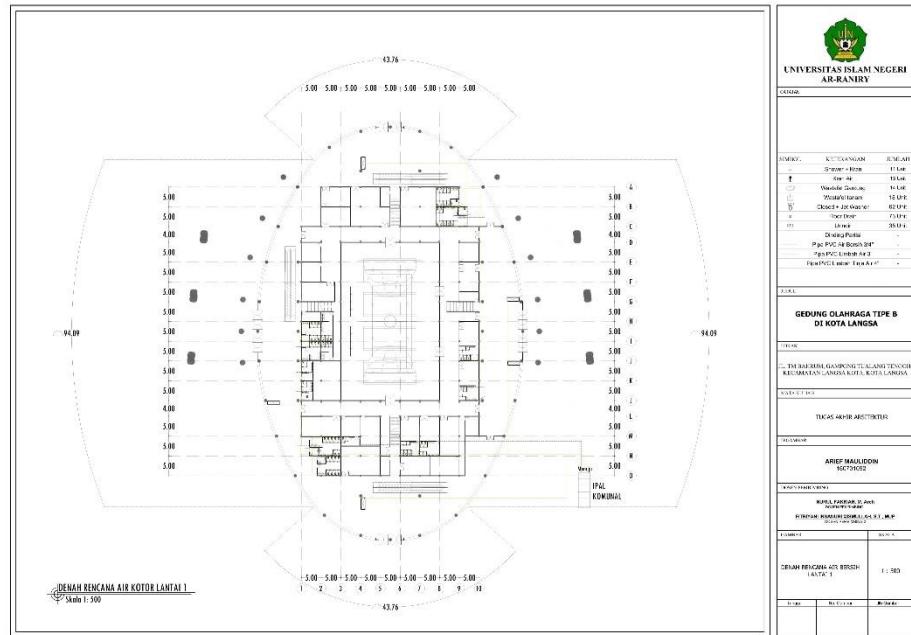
46 Denah Rencana Air Bersih Lantai 1
